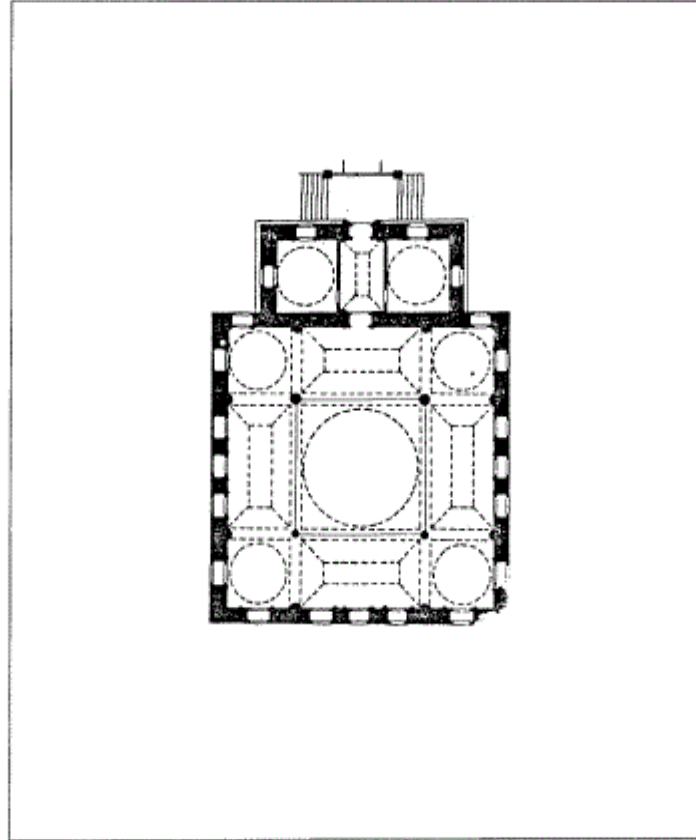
مسقط أفقي لمسجد ومدرسة سوكللو محمد باشا في لولى بورغاز
